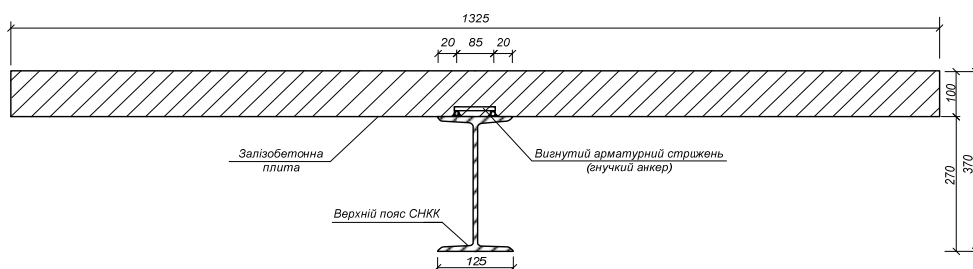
Переріз верхнього поясу сталезалізобетонної конструкції III варіанту після бетонування
